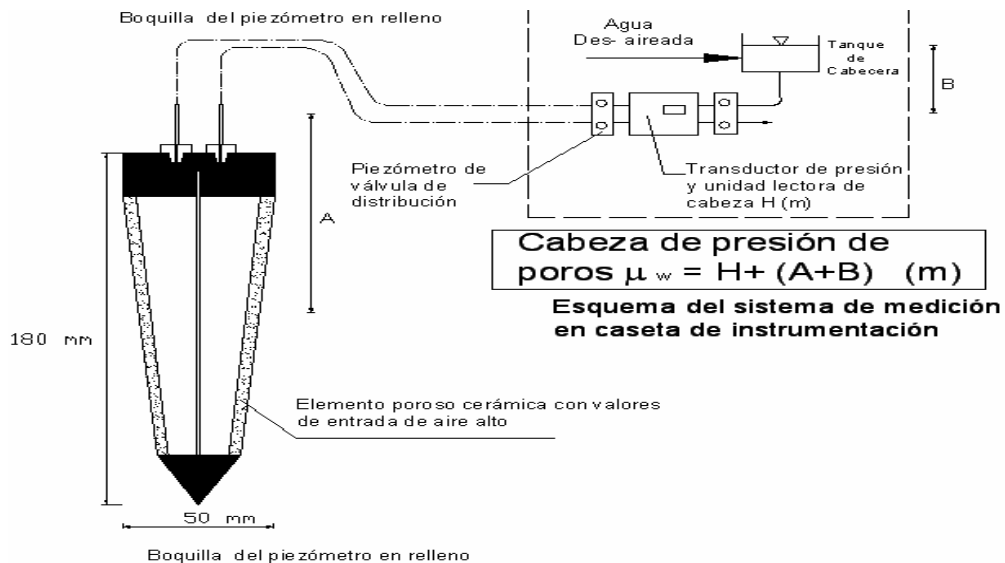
Piezómetro Hidráulico de tipo Bishop de tubería gemela
